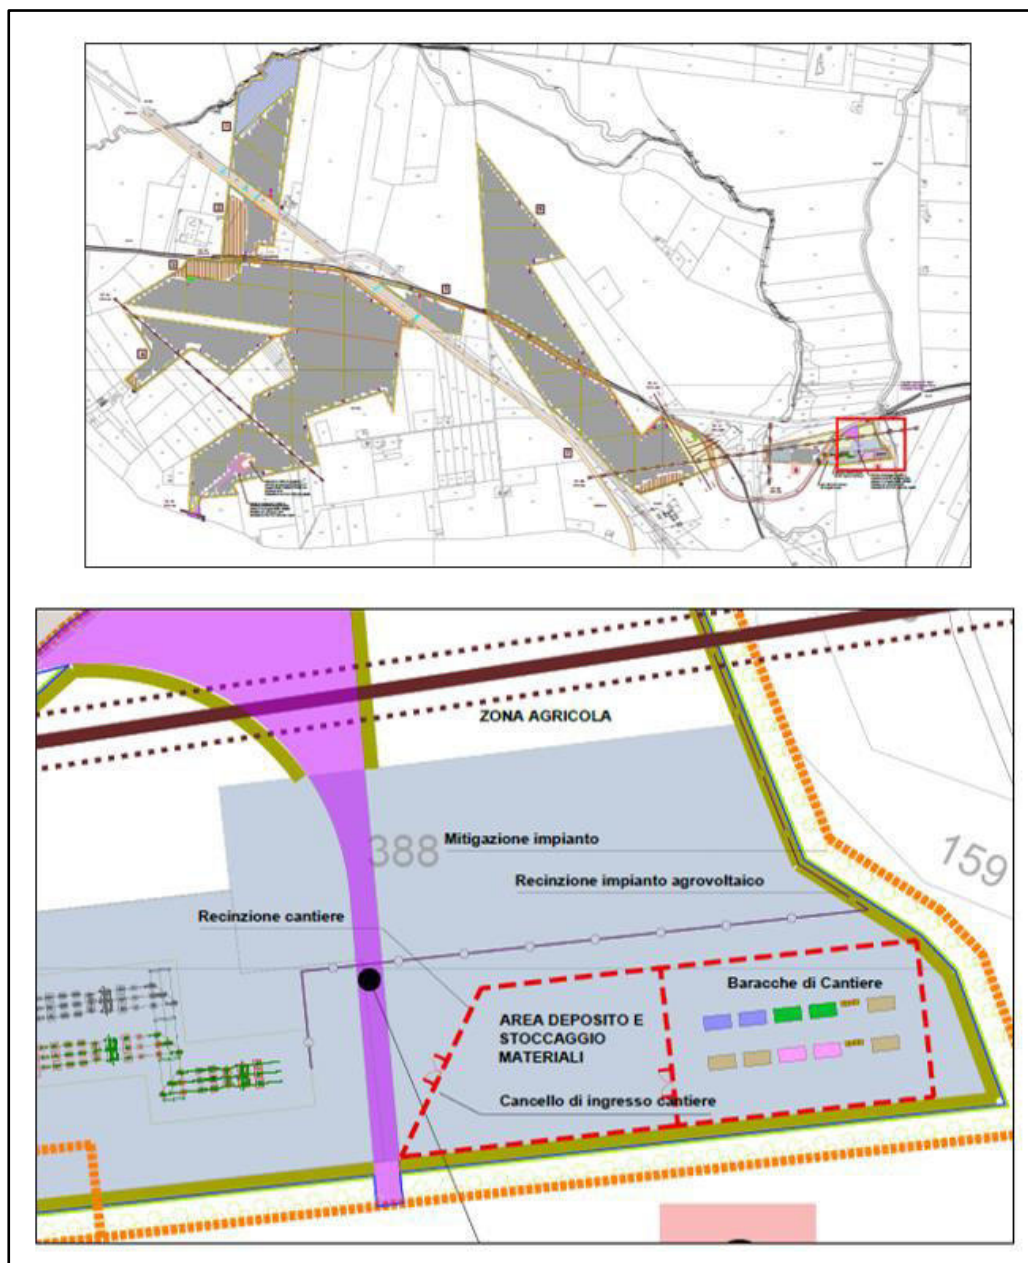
Area di cantiere interna all'area di impianto con dettaglio dell'area di deposito e baracche di cantiere
